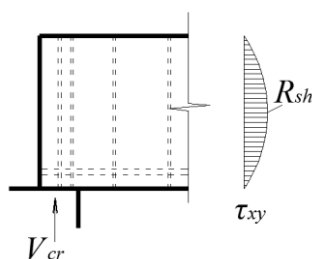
Модель к расчету усилия образования наклонных трещин II типа в зоне среза изгибаемого железобетонного элемента [3]
